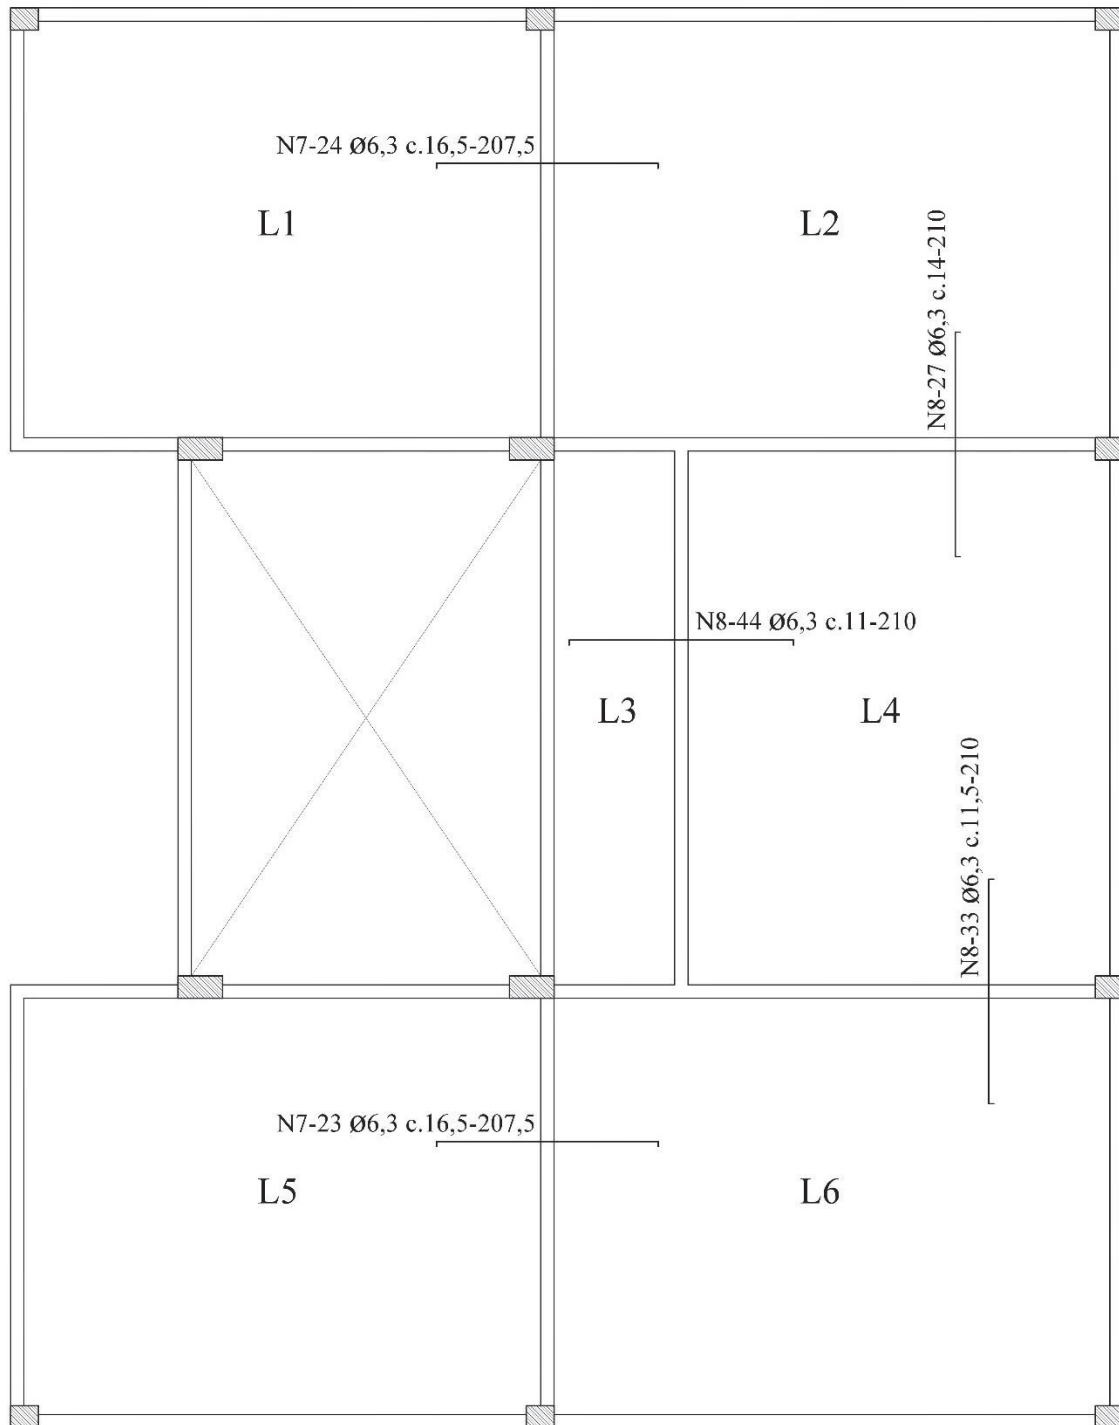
Detalhamento das armaduras positivas (análise elástica)
